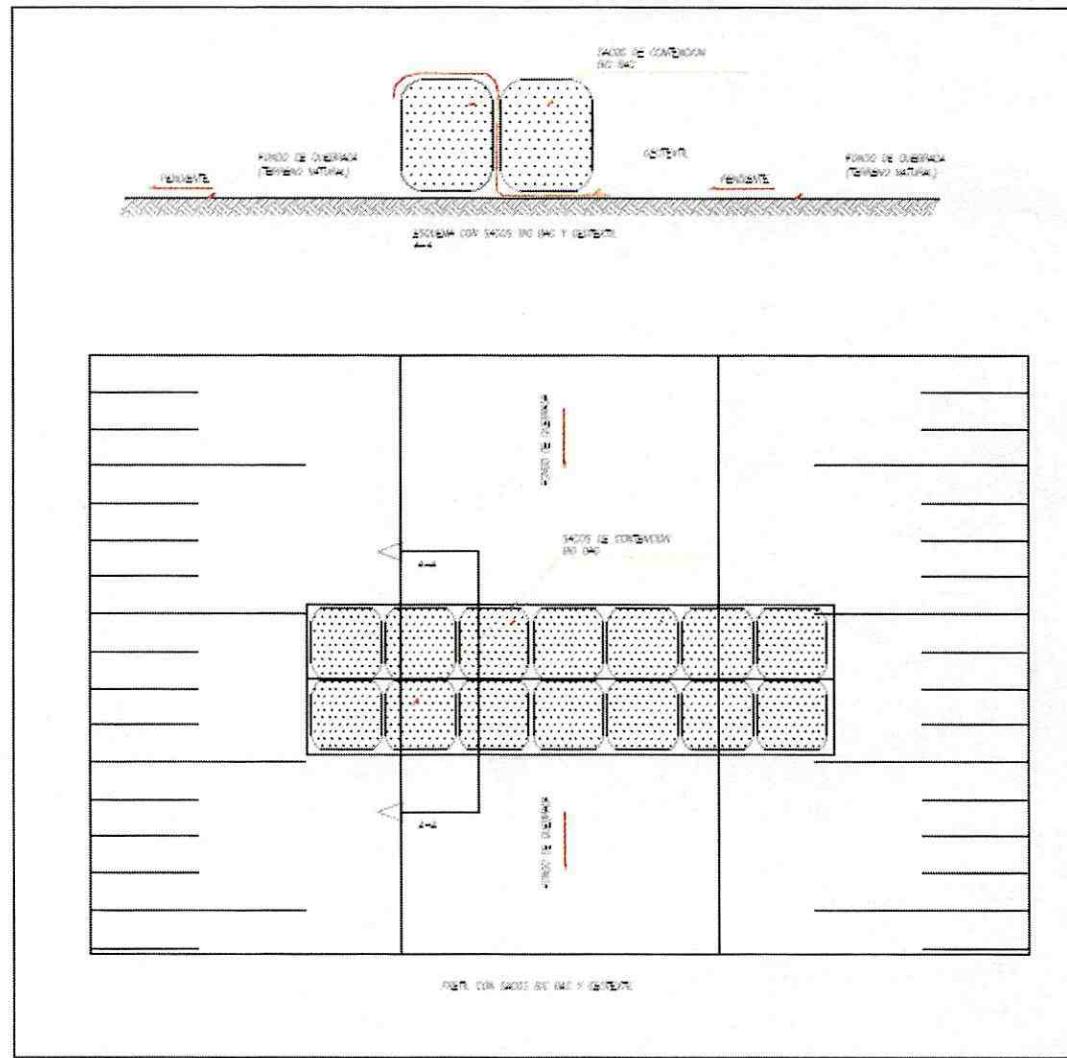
, Plano de Planta, y Perfil de Pretil Intermedio
